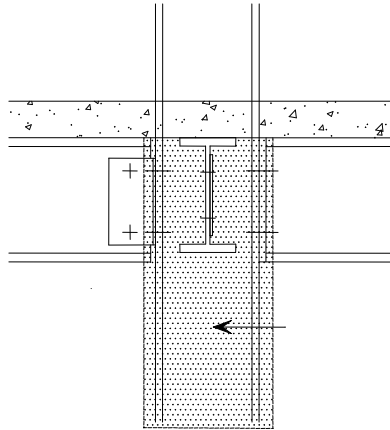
Etendue de la protection contre le feu des poteaux
